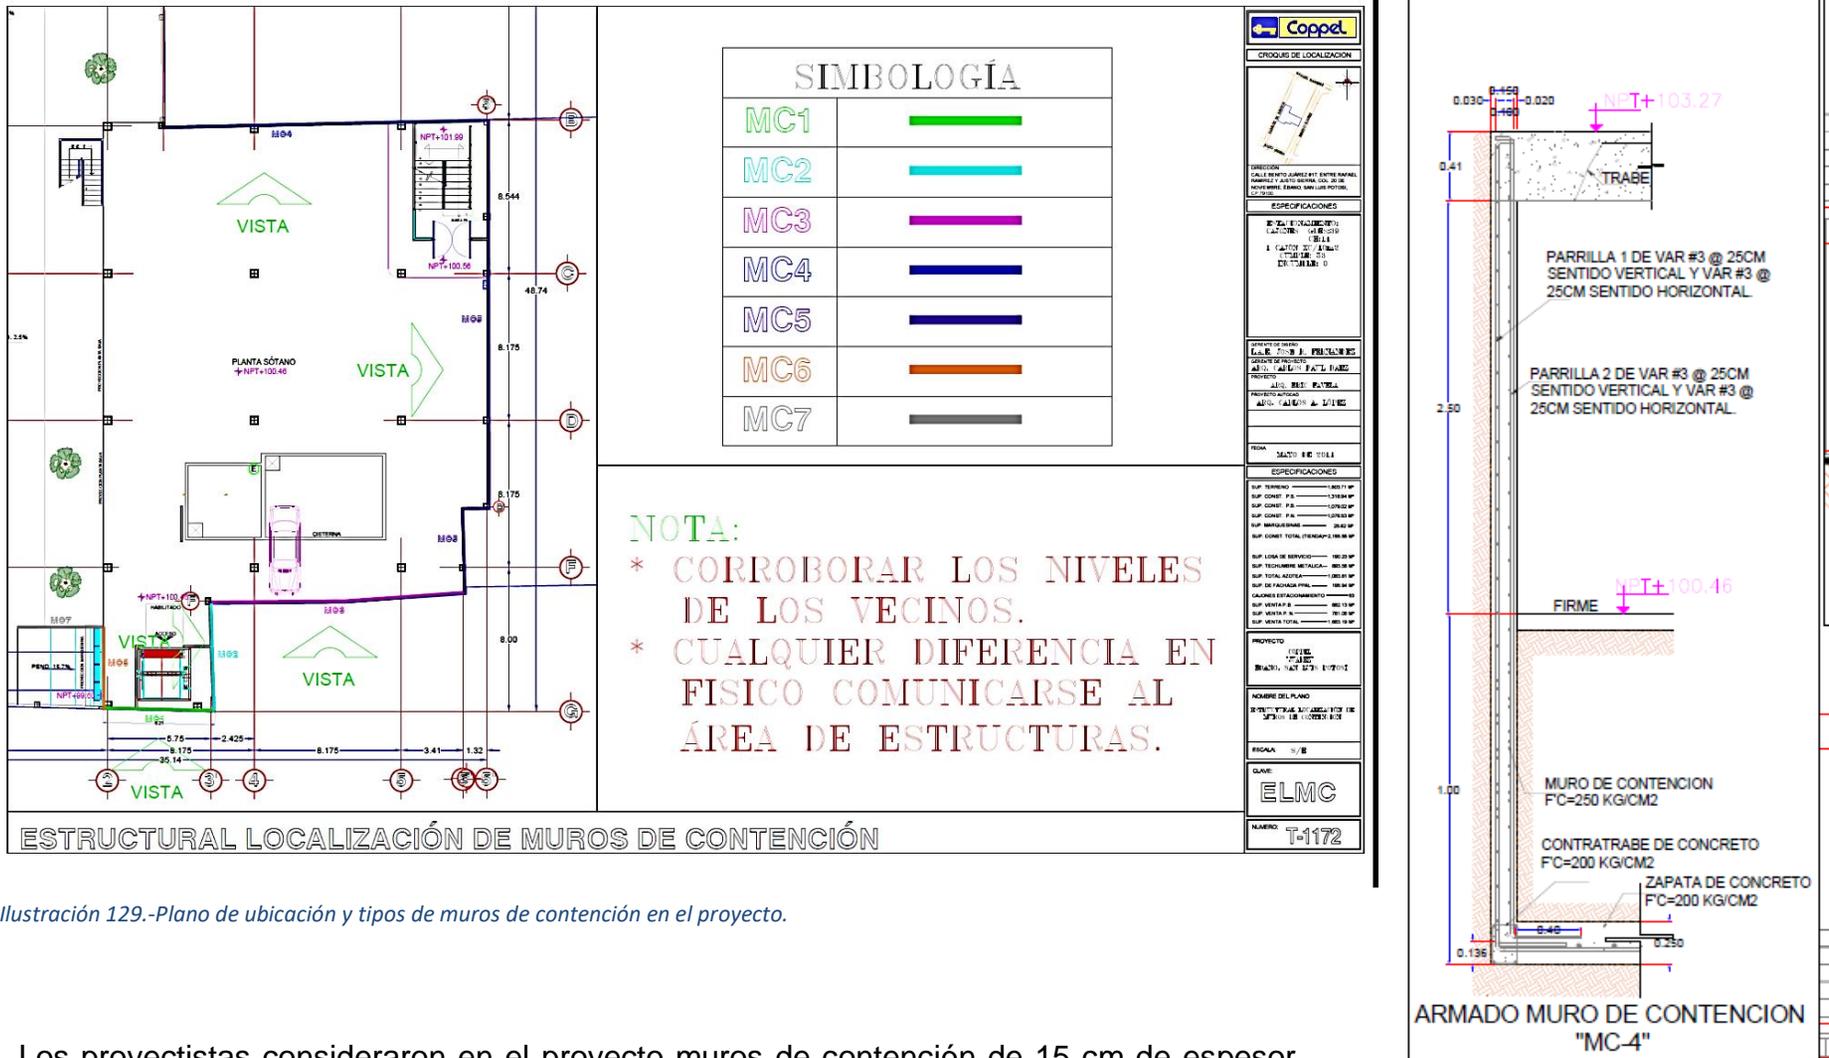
Plano de ubicación y tipos de muros de contención en el proyecto.
